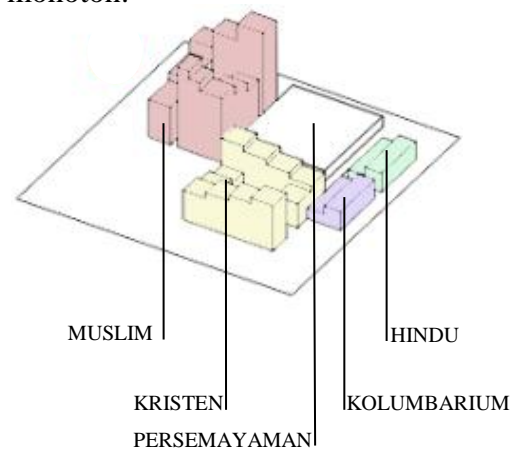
Tahapan perancangan bentukan bangunan
